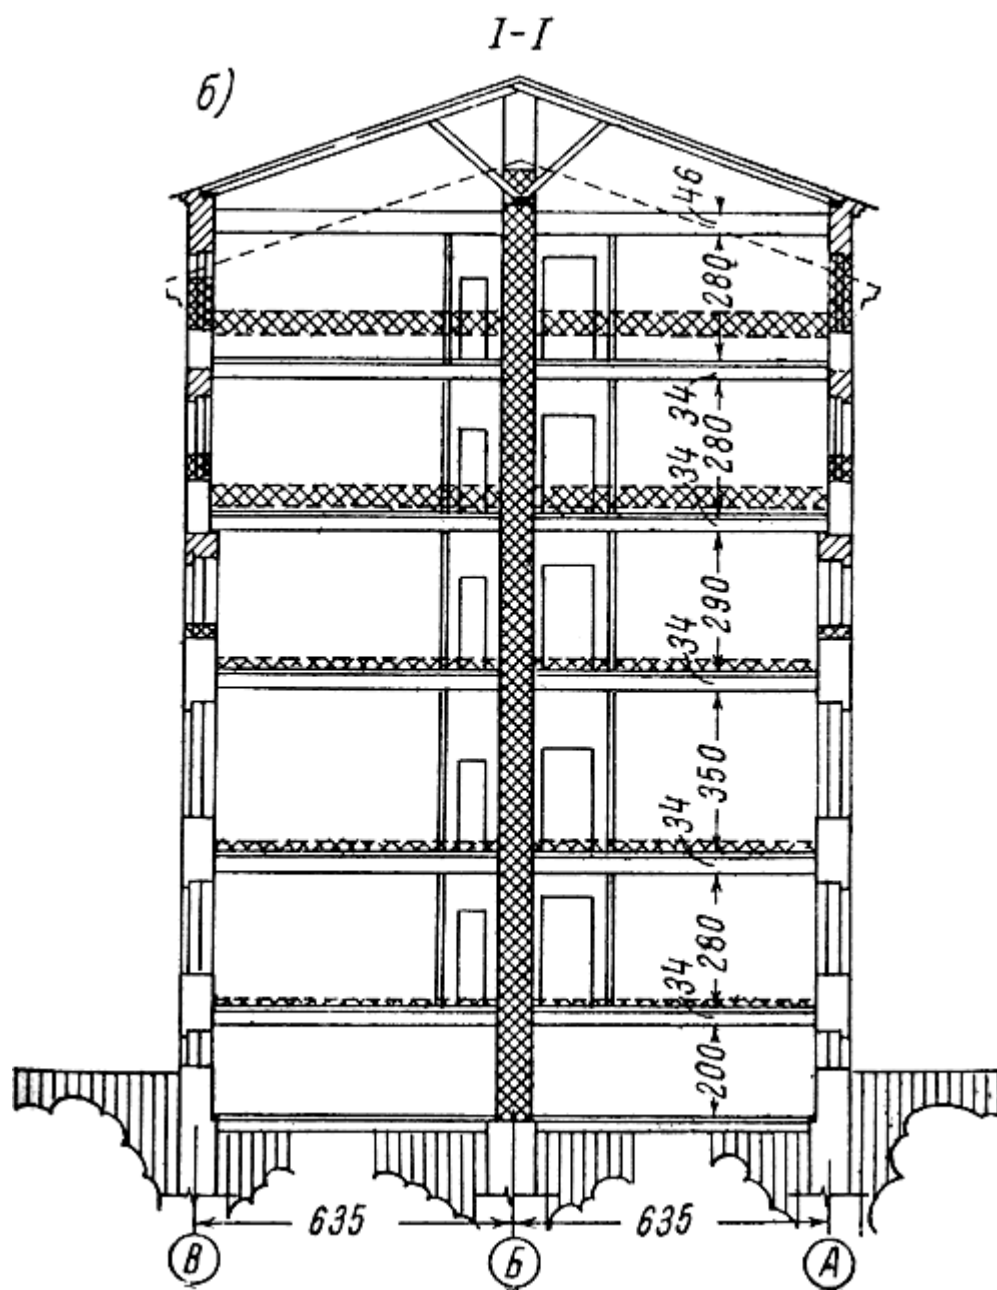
Пример проектного решения по перекладке участка средней продольной стены при капитальном комплексном ремонте жилого дома
